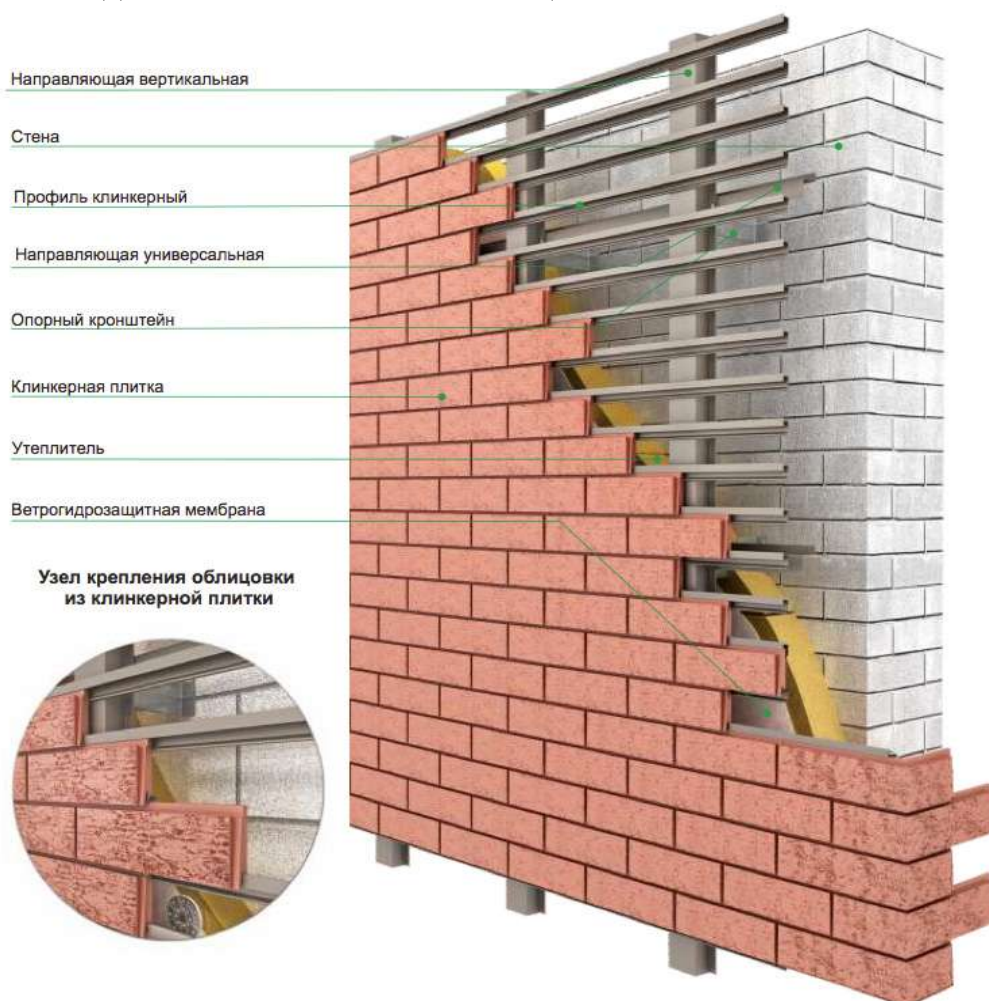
Крепление клинкерной плитки на горизонтальные металлические направляющие в системе навесного фасада
